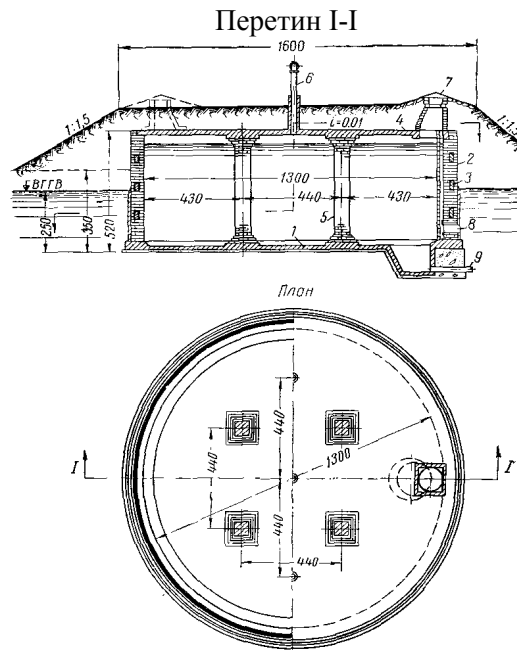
Кам'яний резервуар, посилений залізобетонними кільцями (залізобетонні кільця заштриховані): 1 – залізобетонне днище; 2 – кам'яний (цегляний) корпус, посилений залізобетонними кільцями; 3, 4 – залізобетонні перекриття; 5 – кам'яні колони; 8 – приймально-роздавальний патрубок; 9 – труба для бруду
